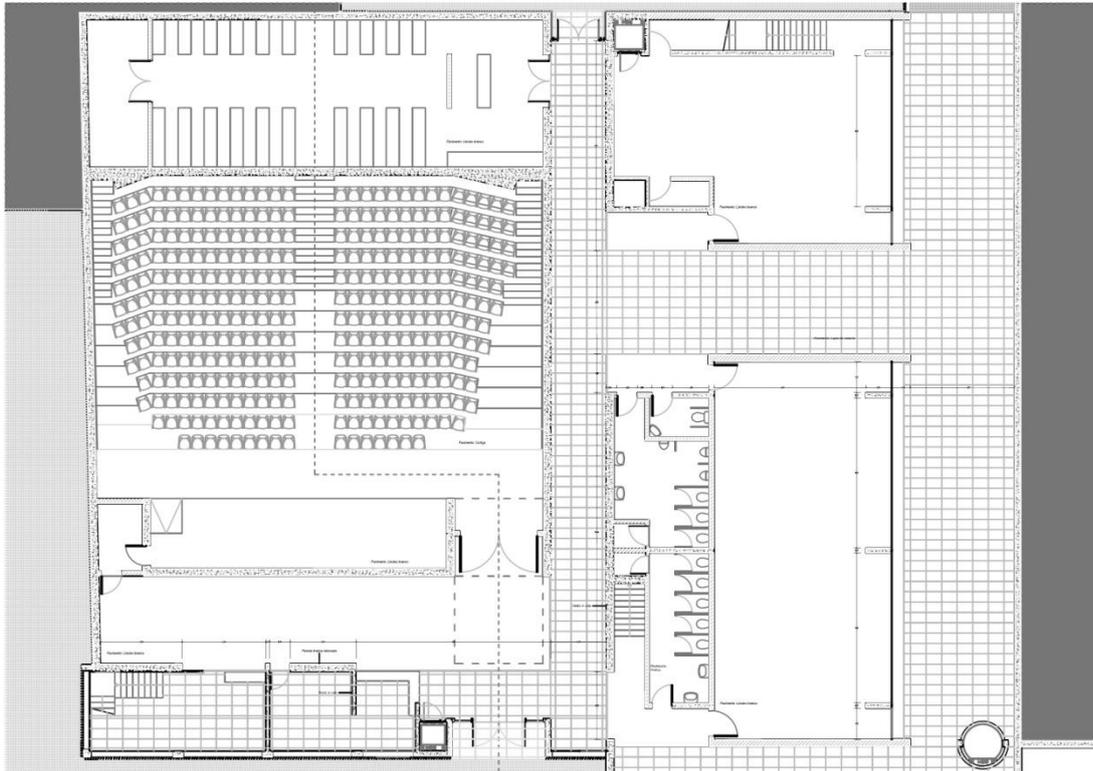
Detalhe construtivo de parte da planta do piso -1 da Faculdade de Arquitectura
